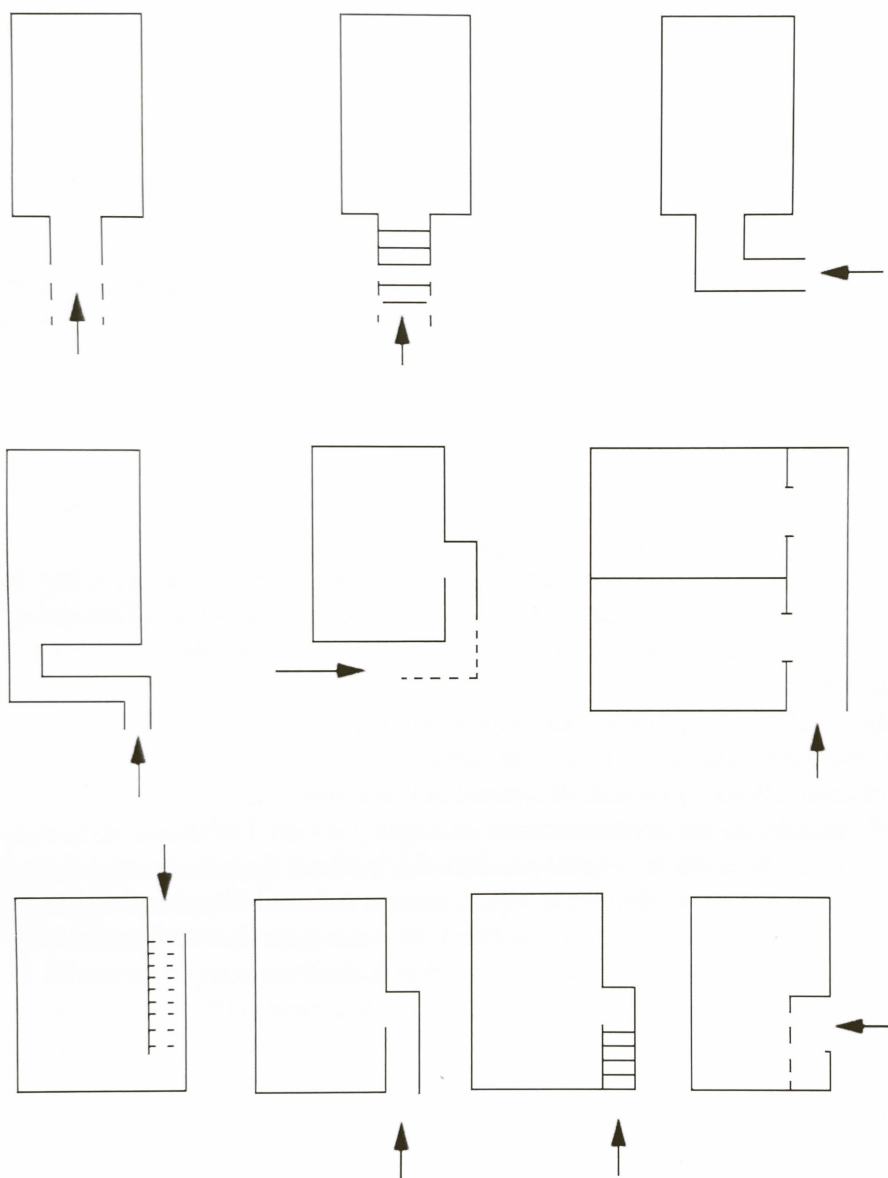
Hausgrundrisse und Zugangs-schemata von Gebäuden des Typs «casa retica» im Alpenraum.
